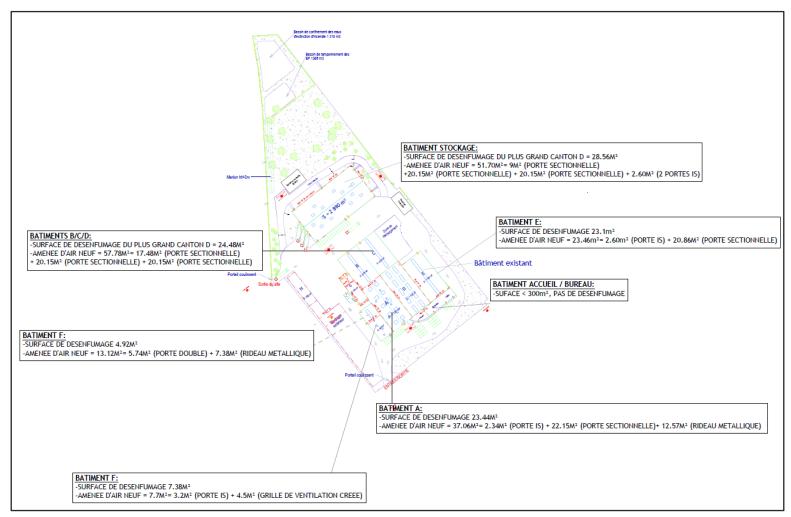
PJ24bis26 - PLAN DETAIL DESENFUMAGE ET ENTREE D'AIR (source: sicabconstruction)
